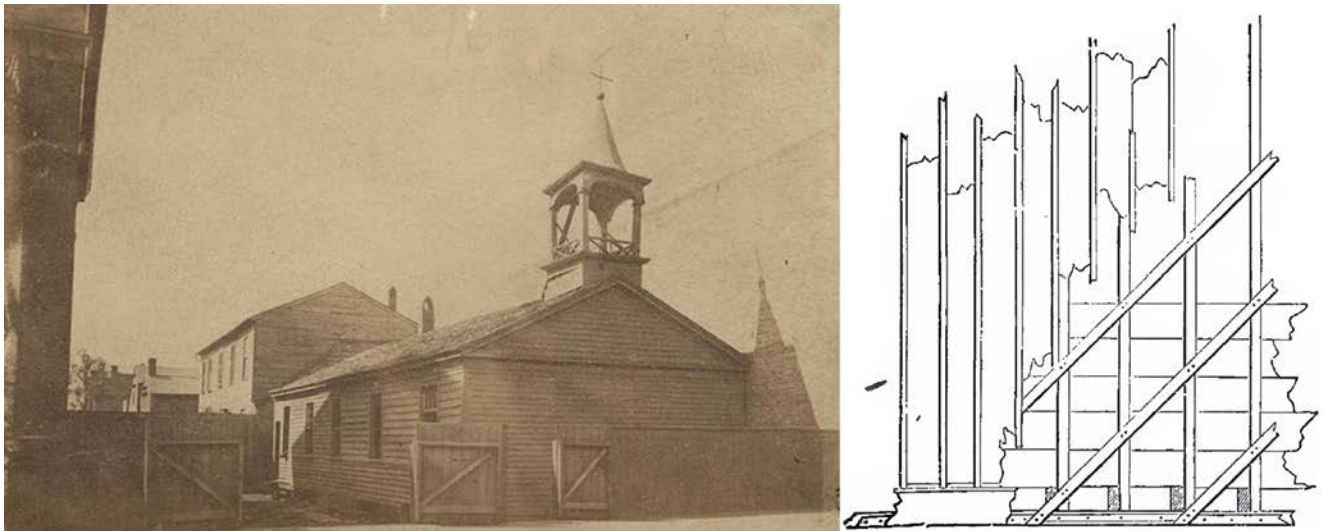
Iglesia de Santa María de Chicago (Chicago Historical Society) y vista interior del sistema constructivo balloon frame y diagonales de refuerzo para la ejecución del revestimiento (Cornell University Library).
